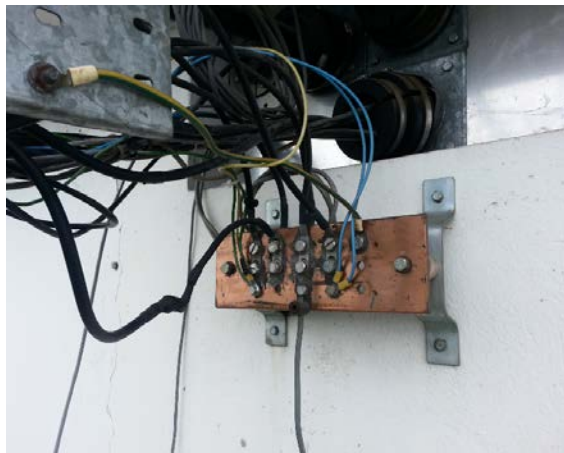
Protección contra rayos instalada en el exterior junto a la torre de Miravalle
